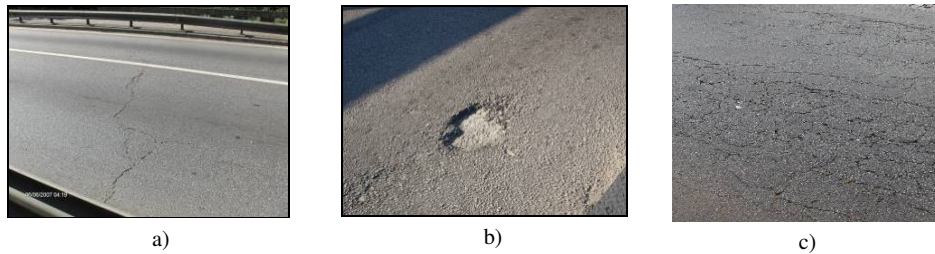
Exemplos de patologias no revestimento da via: a) Fendas no pavimento; b) Buraco no pavimento; c) Fendilhação em “pele de crocodilo”
